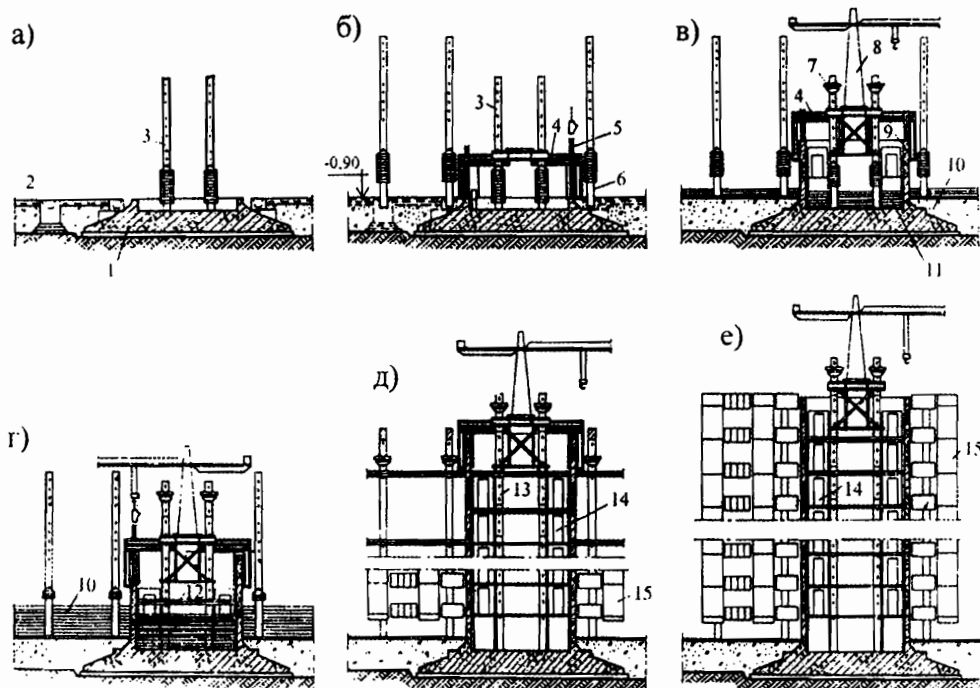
Последовательность выполнения строительно-монтажных работ: а...е - этапы возведения здания; 1 - фундамент ядра; 2 - фундамент под отдельно стоящую колонну; 3 - внутривольная колонна с нанизанными воротниками; 4 - подкрановая платформа агрегатного устройства; 5 - арматурный каркас ствола; 6 - колонна каркаса здания; 7 - подъемник; 8 - башенный кран СКК-5-20; 9 - ствол ядра жесткости; 10 - пакет плит перекрытий здания; 11 - пакет внутривольных плит перекрытий; 12 - две внутривольные плиты, поднимаемые до уровня нижних связей агрегатного устройства; 13 - внутривольные колонны верхних ярусов; 14 - элементы конструкций лестниц и лифтов; 15 - ограждающие конструкции этажей здания
